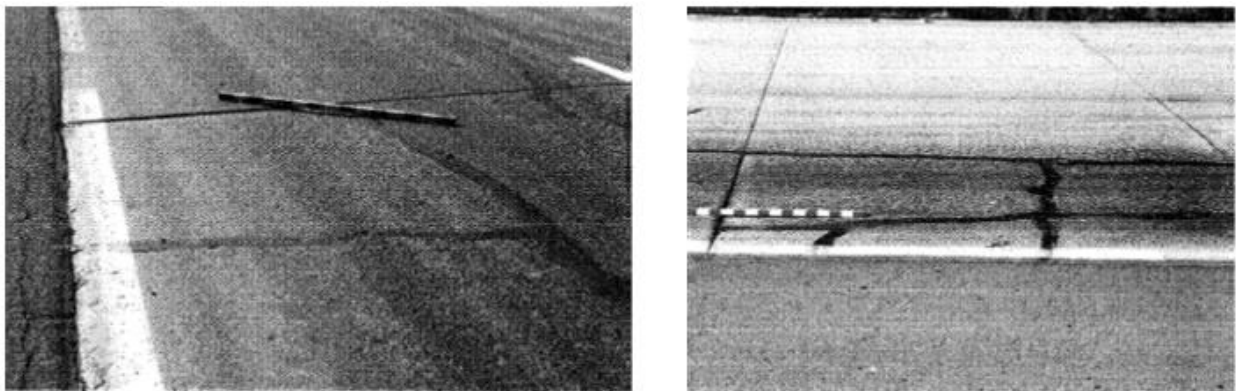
Fissure en « Balles » d'une chaussée rigide
